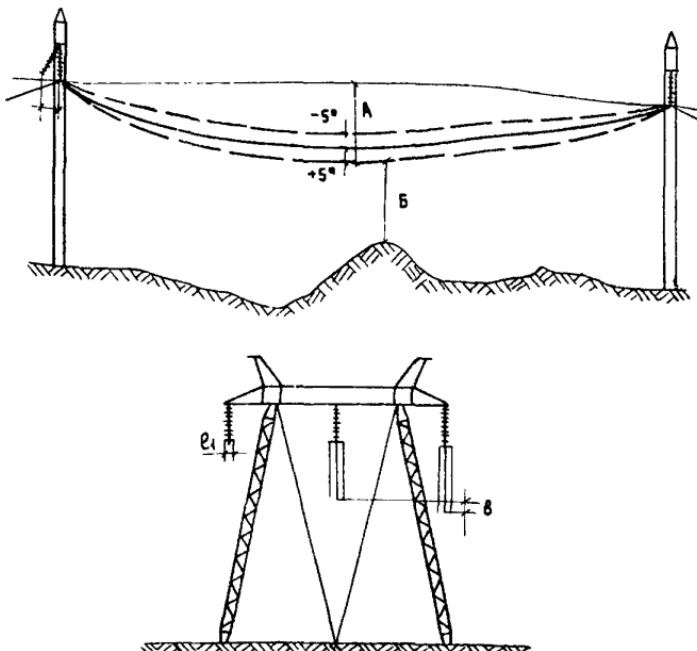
Нормы и допуски на монтаж проводов
